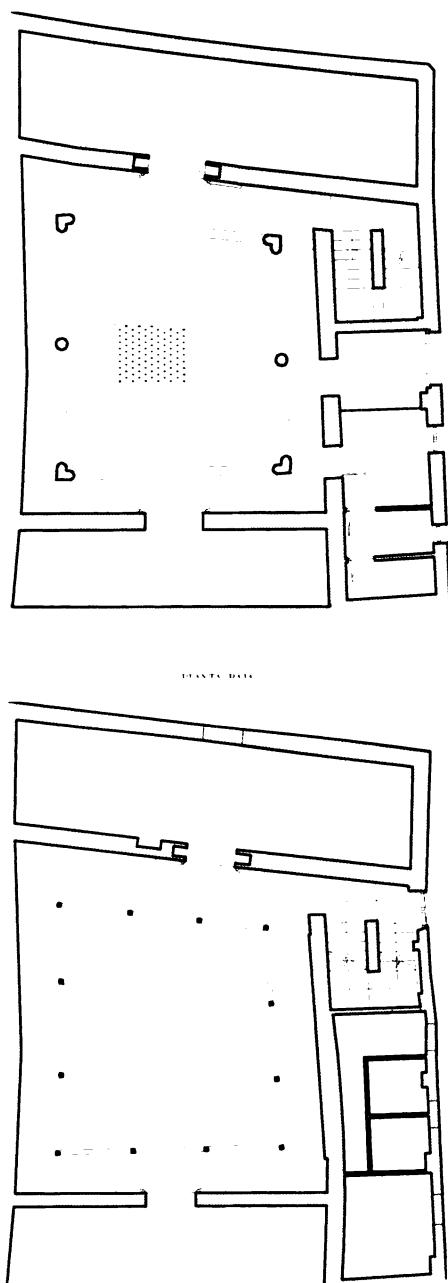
Casa morisca de la Calle de San Buenaventura, nº 7 (Granada): Plantas baja y alta.
